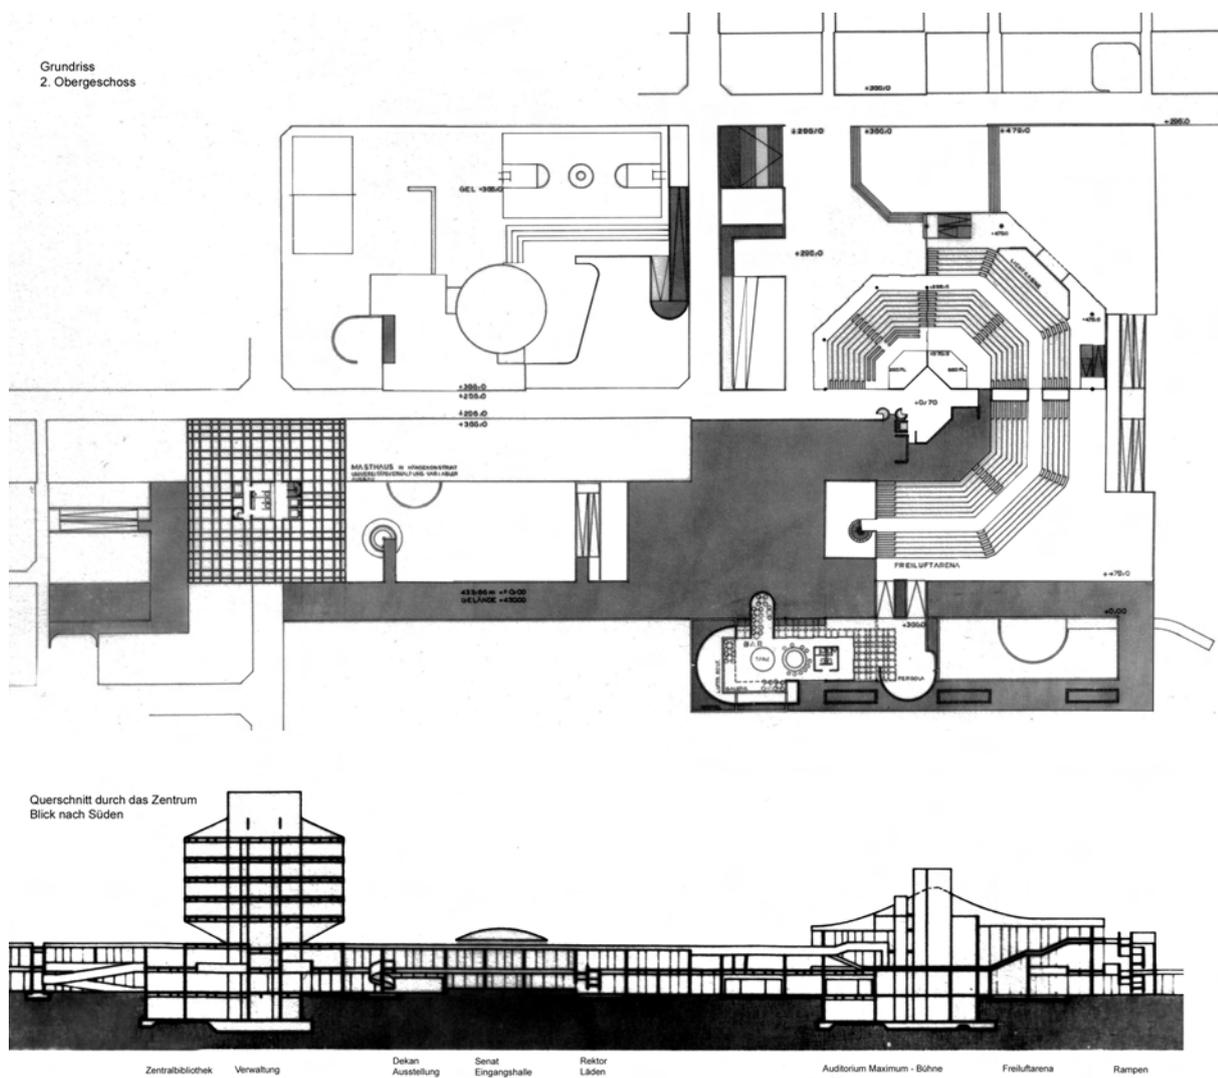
oben - Grundriss 2. Obergeschoss, unten - Querschnitt
